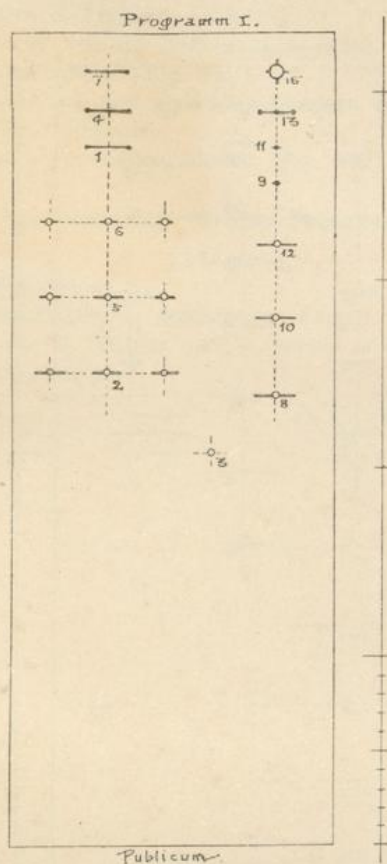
Feuerwerksaufstellung, Grundriss. Programm I.
